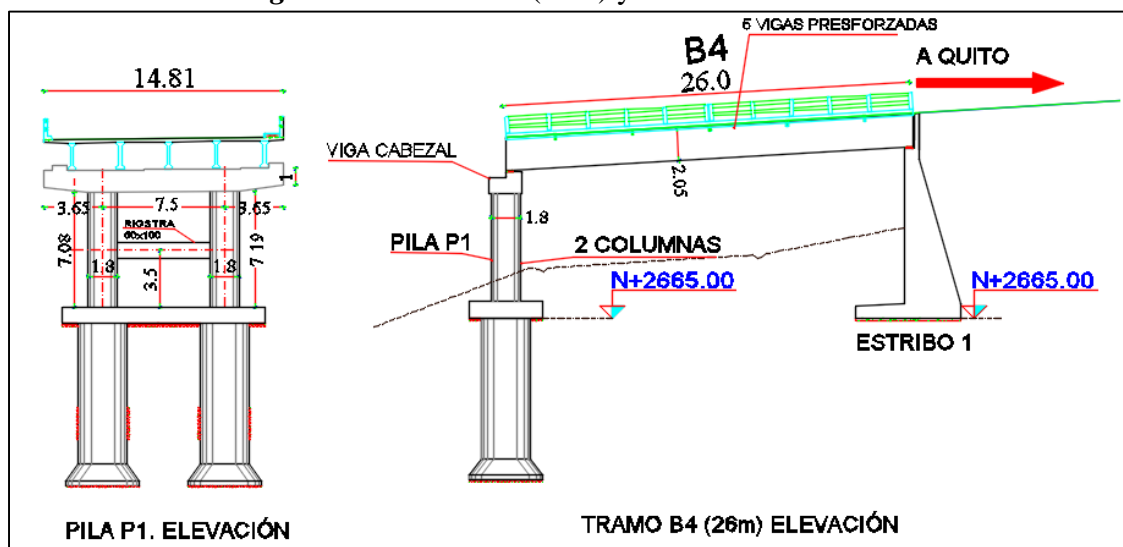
Tramo B4 (26m) y Pila P1 en elevación.
